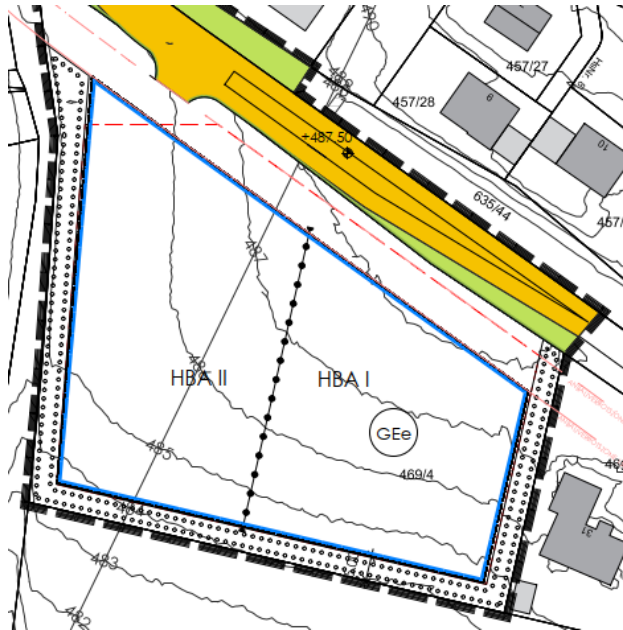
Auszug aus dem Bebauungsplan.
